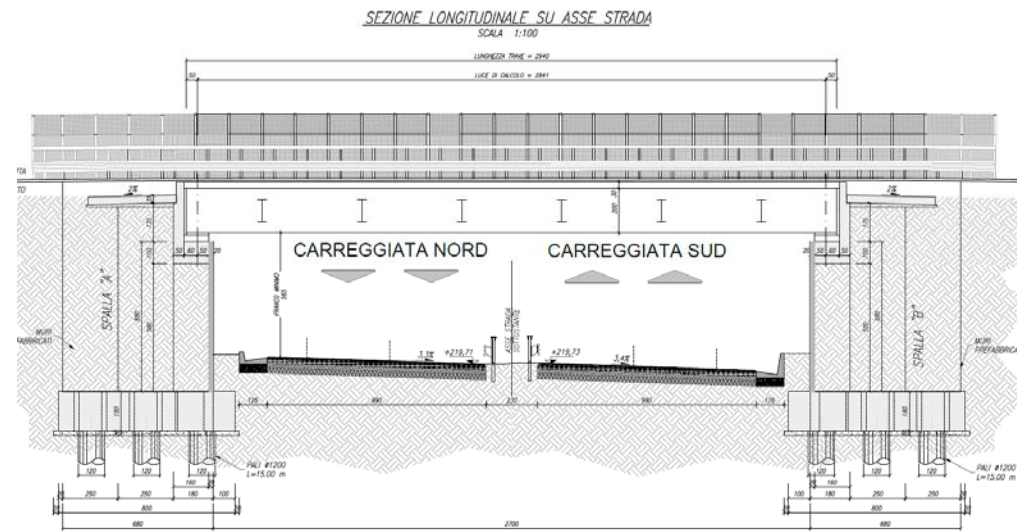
Cavalcavia al Km 7130: Sezione Longitudinale
